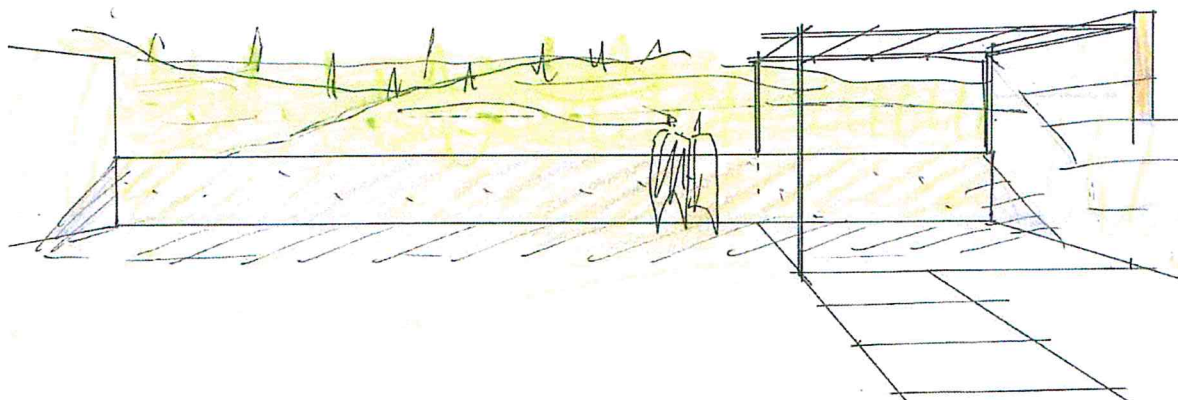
Schizzo di studio relativo alle abitazioni dell'area denominata "il Belvedere". Il muro in sasso sbizzato fungerà da elemento di protezione dalla strada ma assumerà anche il ruolo di orizzonte artificiale verso le colline poste a Sud-Est.
